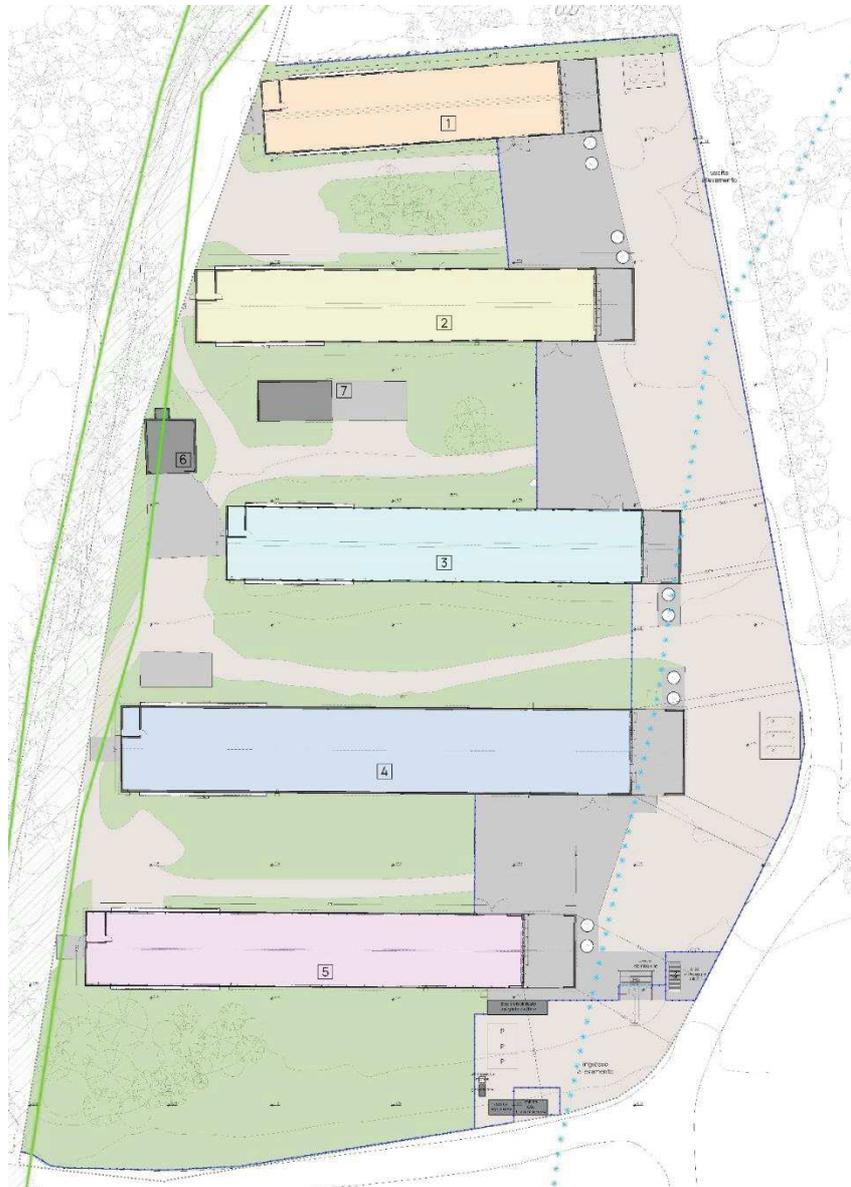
Planimetria dell'allevamento nella configurazione di progetto.
